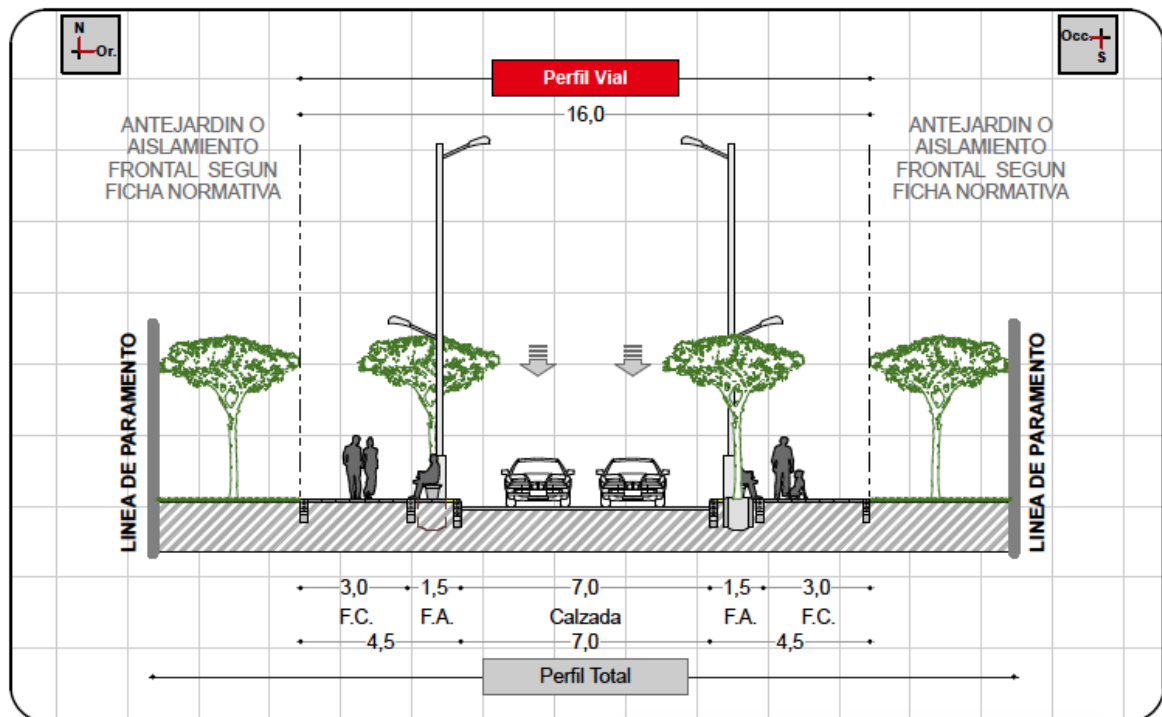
Detalles de Perfiles Viales Tipo, Plancha 5/9, Perfil 16.00mts Tipo C.
